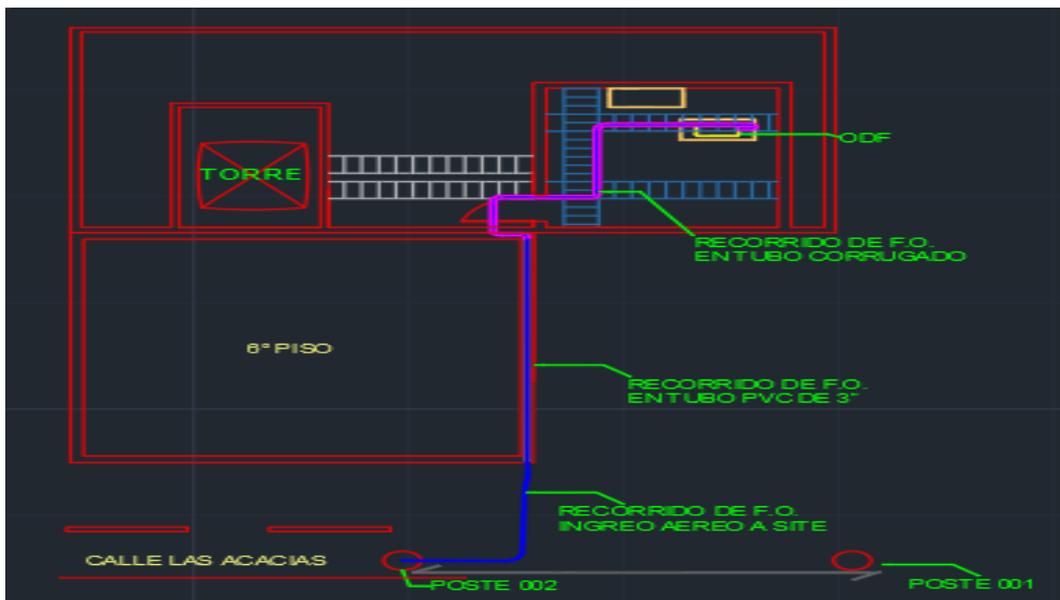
Plano de planta del recorrido del cable y equipo a instalar (ODF) en site García .
